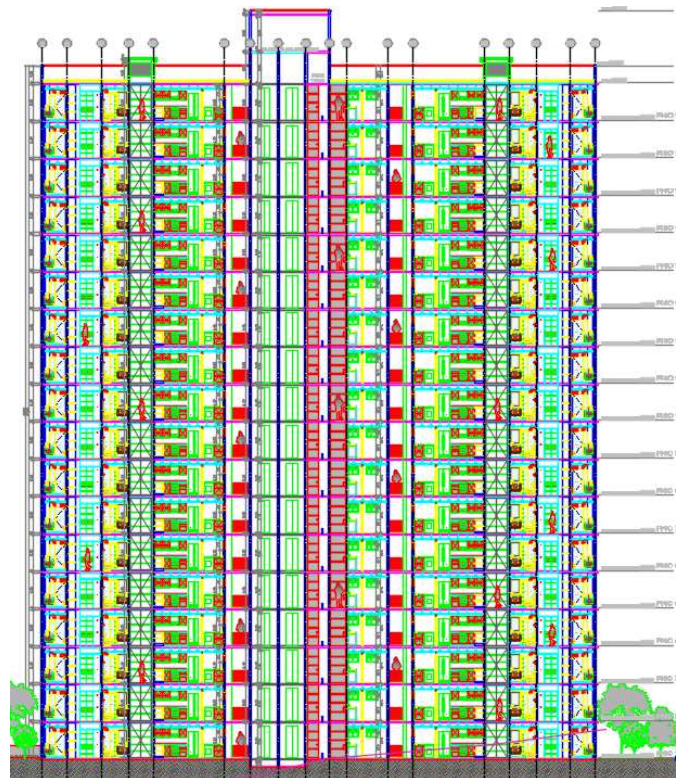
Sección longitudinal de edificación. Fuente: Diseño arquitectónico.
